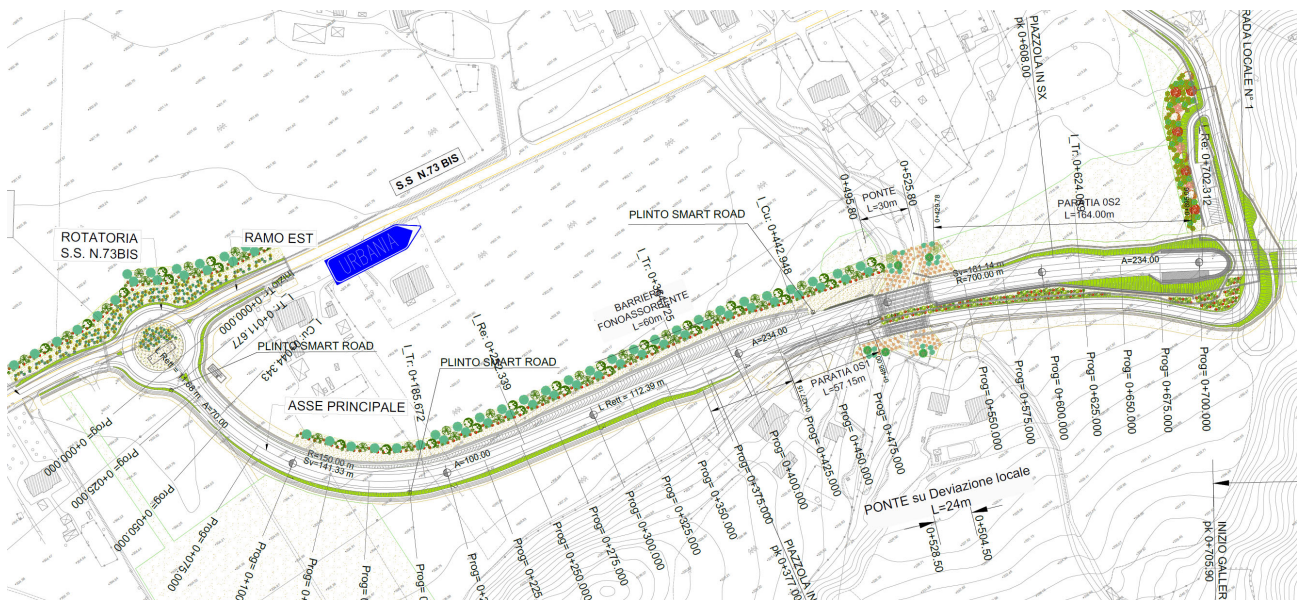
Stralcio Opere a verde-Planimetria - Tav. 1 (T00IA06AMBPL01_B)
